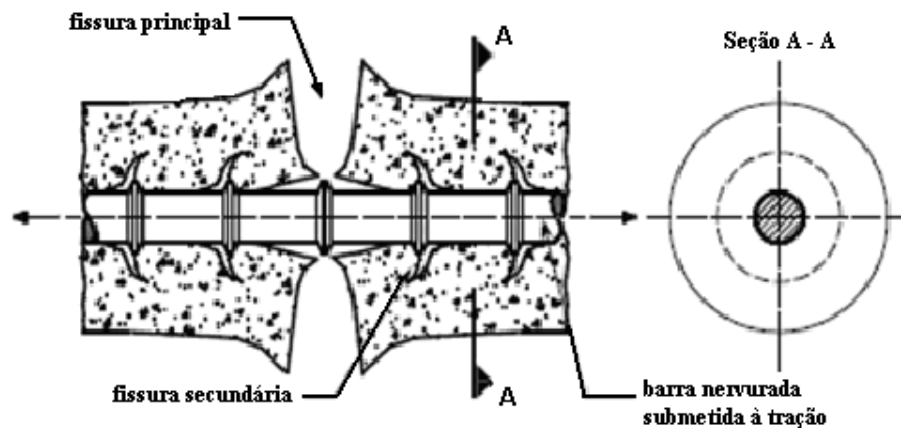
Microfissuras (fissuras secundárias) entre fissuras principais, em uma barra de concreto armado sob tração centrada [adaptado de Goto, 1971].
